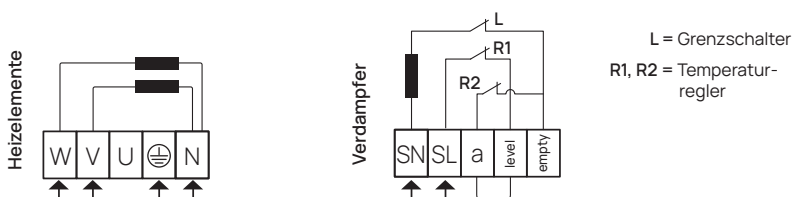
Anschlüsse CORE Wall Mini und CORE Wall Mini Combi.
